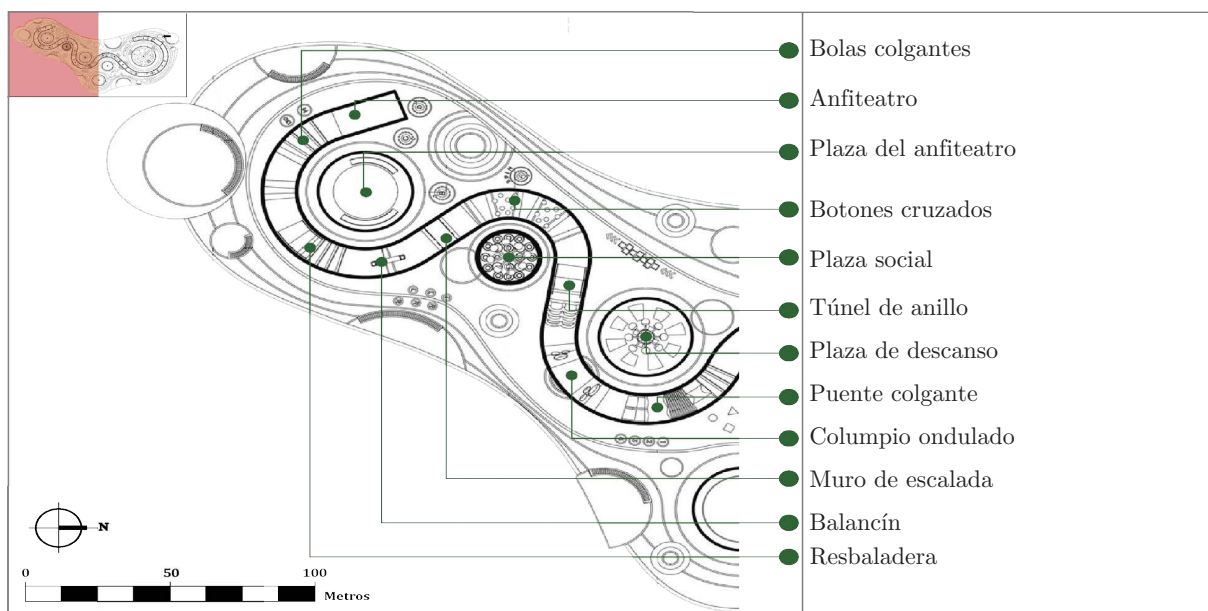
Componentes de la planta arquitectónica. Fuente: [100architects \(2021\)](#).Elaboración: Propia.
